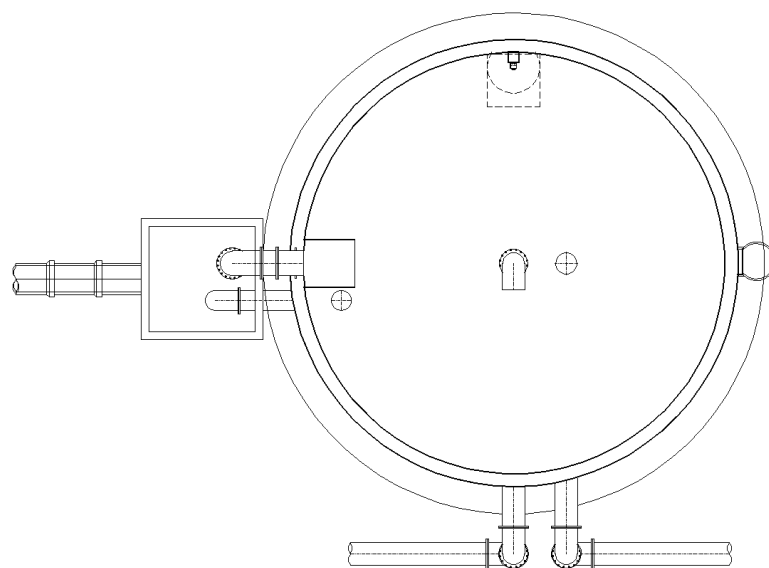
Esquema em planta do reservatório circular elevado de concreto (Reservatório Tipo 2)
